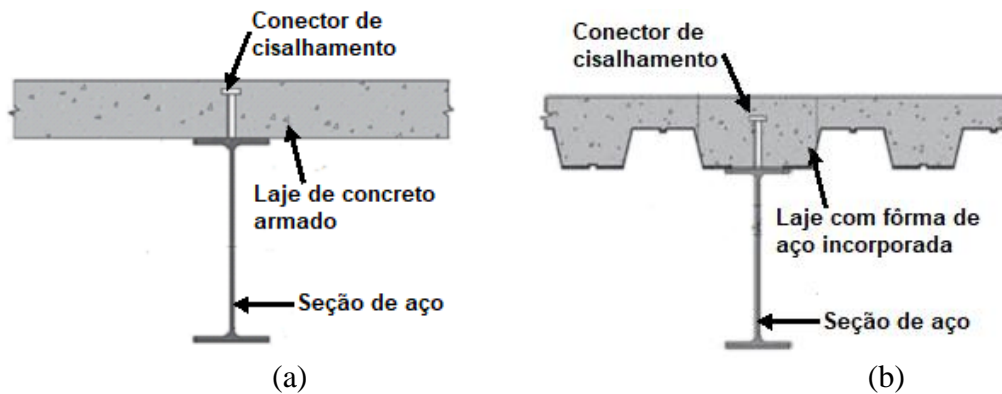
Estruturas mistas aço e concreto (a) Laje maciça (b) Laje com nervuras longitudinais à viga – Fonte: Adaptado de Queiroz (2012).
